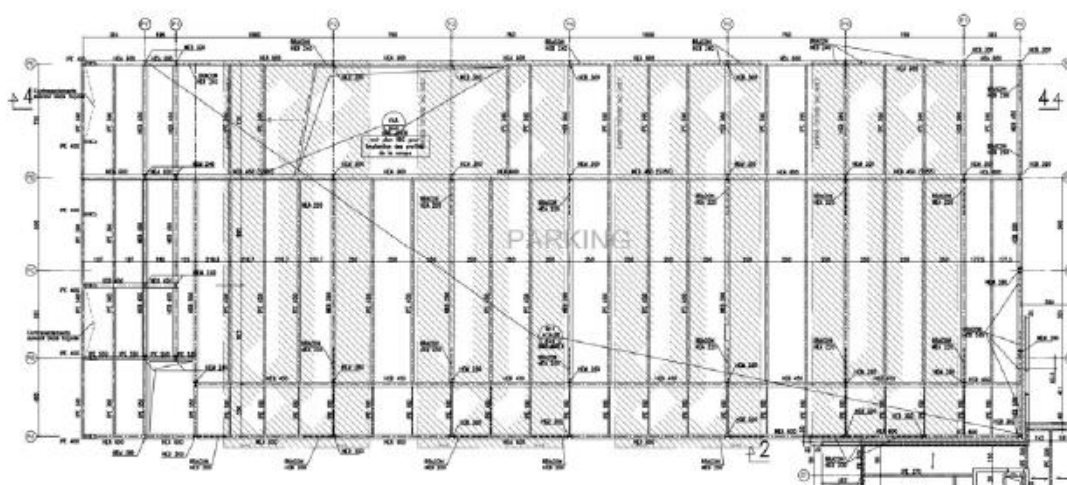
Plan de l'ossature du niveau R+4 du parc de stationnement en superstructure
